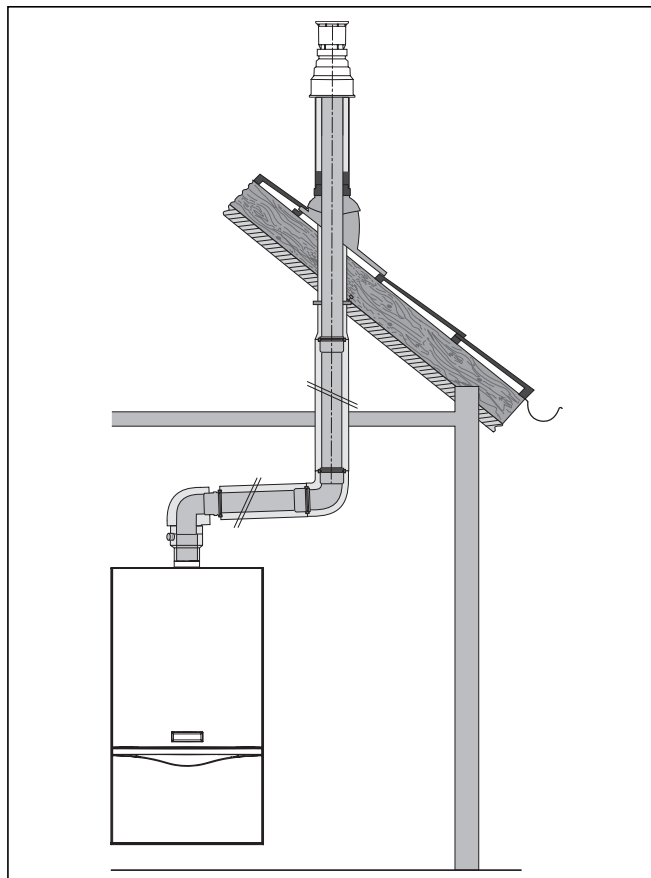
Montaż urządzenia i przepustu przez dach w wypadku dachu pochylego
